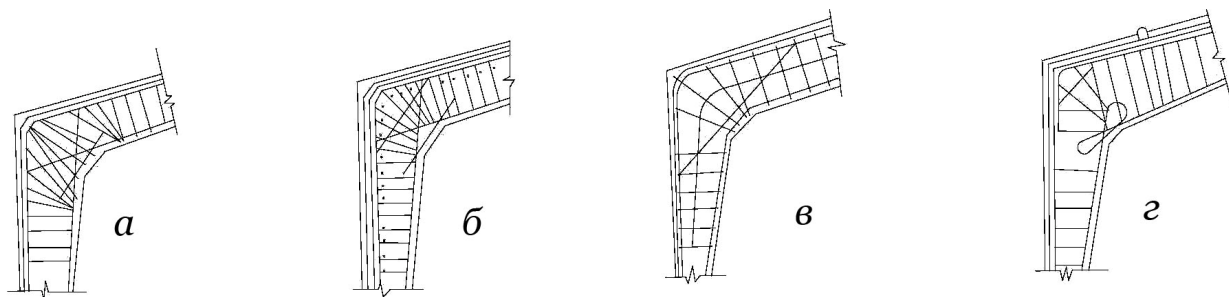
Схема армирования узлов соединения ригелей со стойками, которые были запроектированы: а – Главпроектстроем; б – Приволжгипросельстроем; в – Росгипросельхозстроем; г – ВЗИСИ
